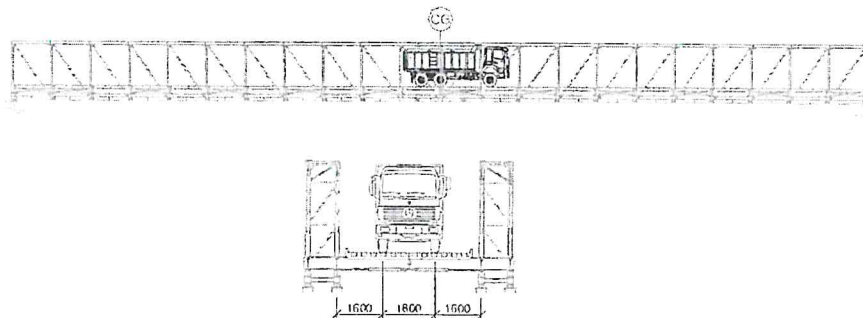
POSICIÓN DE LA CARGA DEL ENSAYO (ALZADO Y CORTE TRANSVERSAL)
